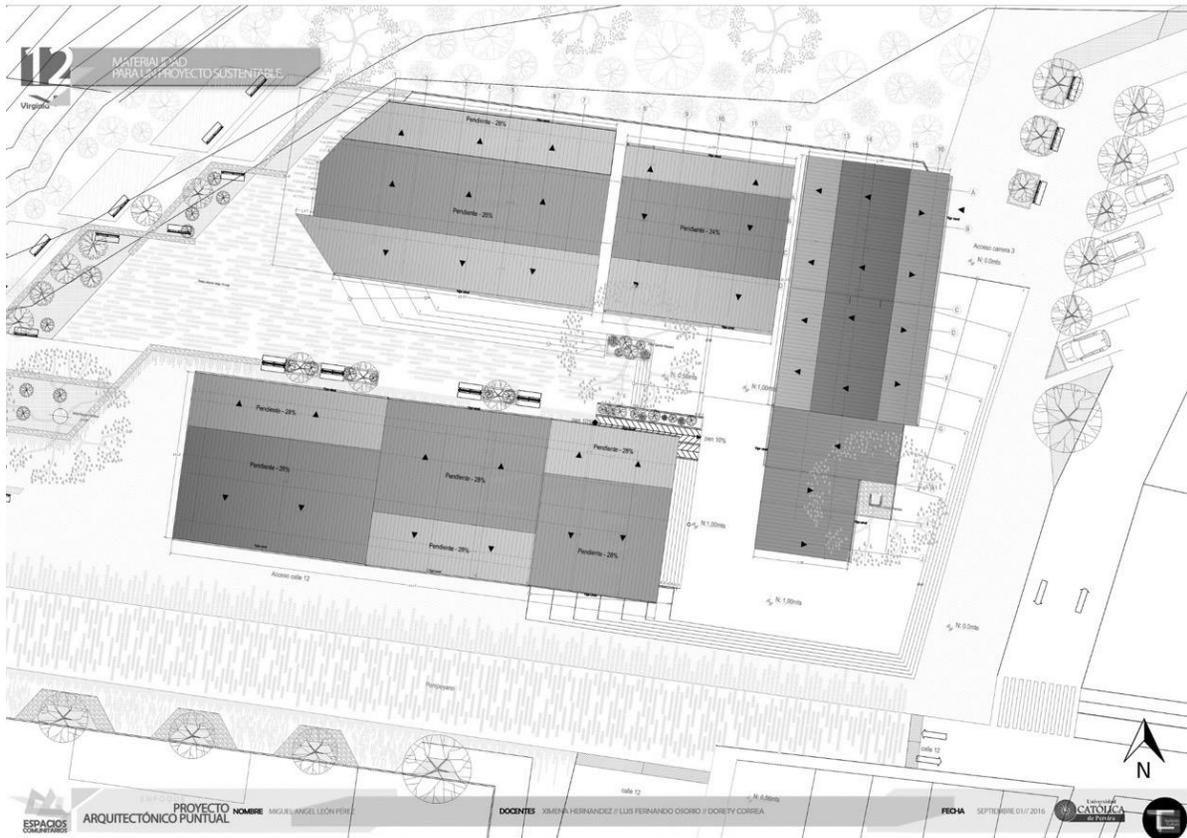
Planta cubiertas. Fuente: elaboración propia.
